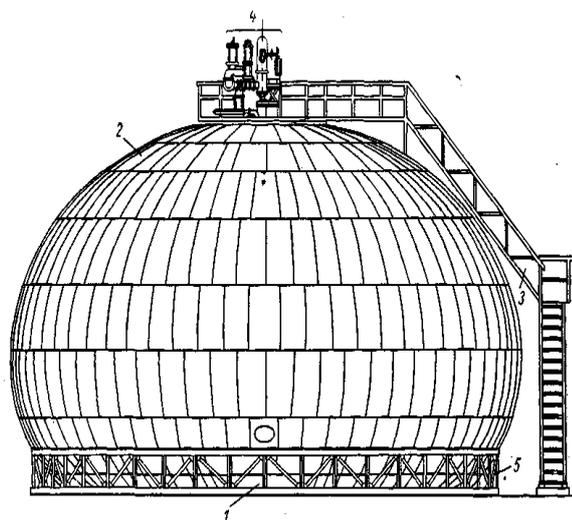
Каплевидный резервуар: 1 – днище; 2 – элемент штампованный; 3 – лестница; 4 – оборудование вспомогательное; 5 – кольцо опорное.
